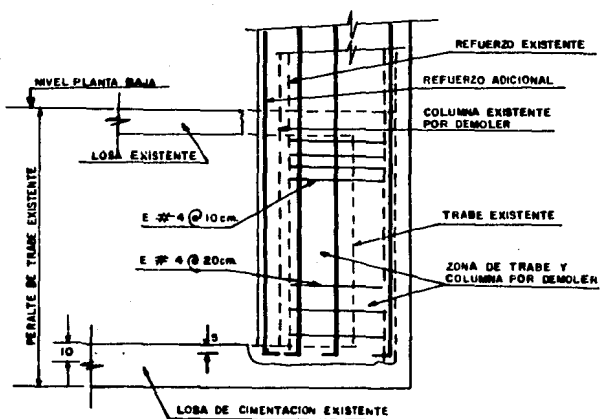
ANCLAJE DE MURO EN LA CIMENTACION
